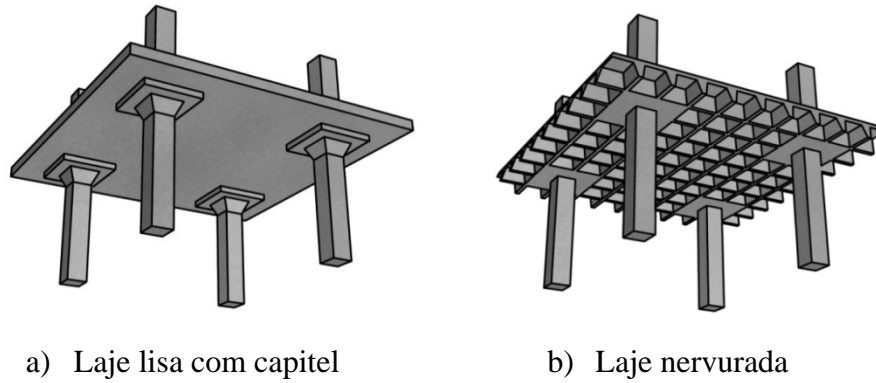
Sistemas estruturais para edificações. [CANEIRO (2015)]
